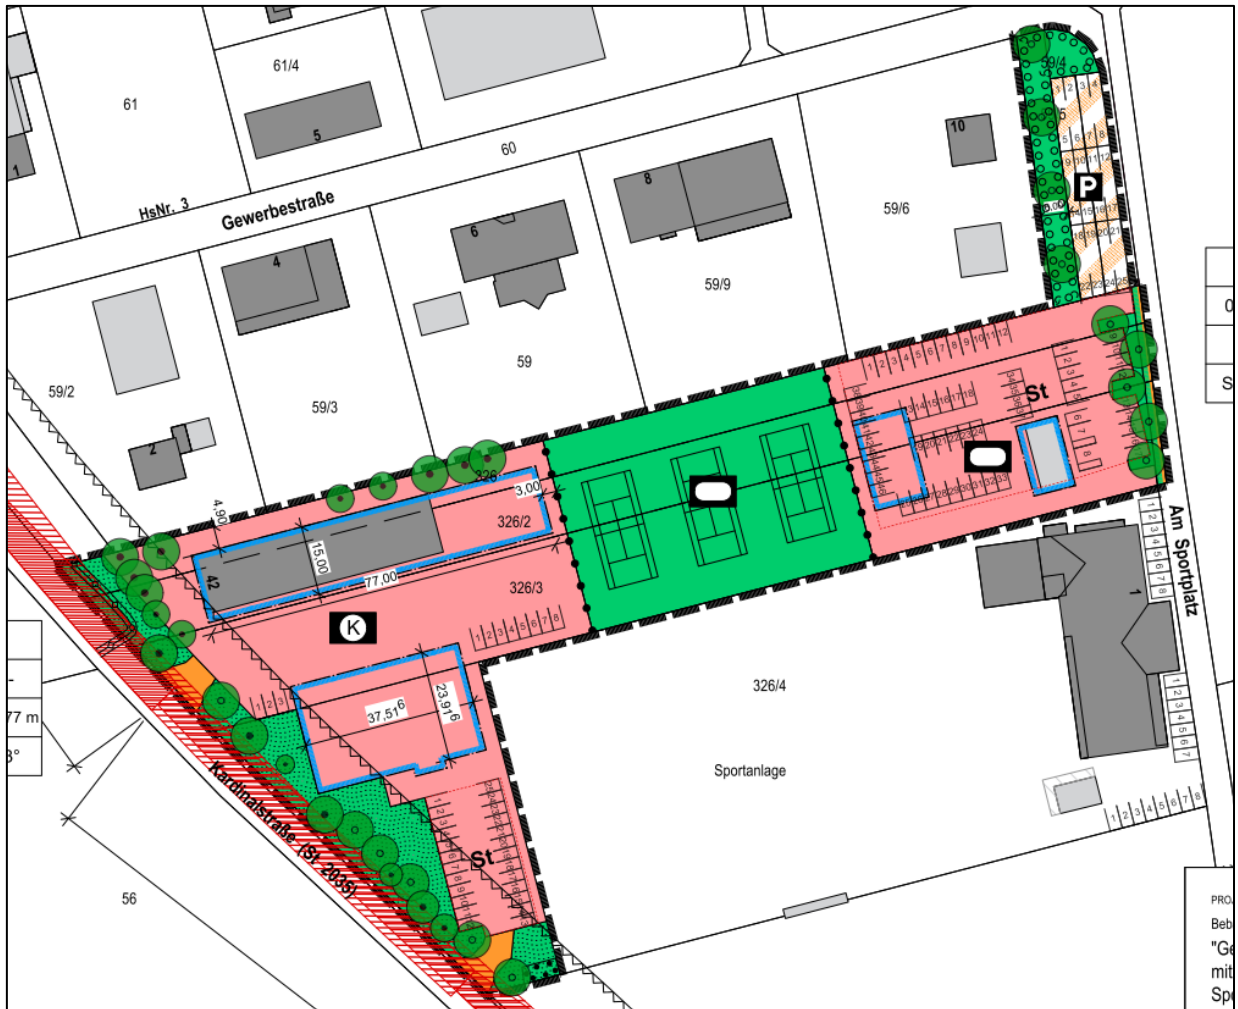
Umgriff Bebauungsplan mit Stand vom August 2023 [23]
